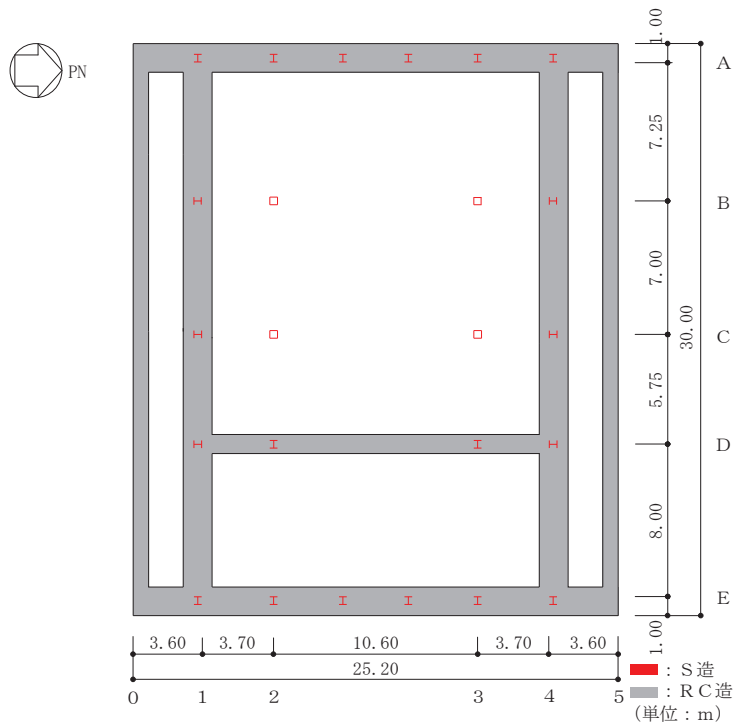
(1) 緊急用電気品建屋の概略平面図(0. P. \* 56. 4m)
